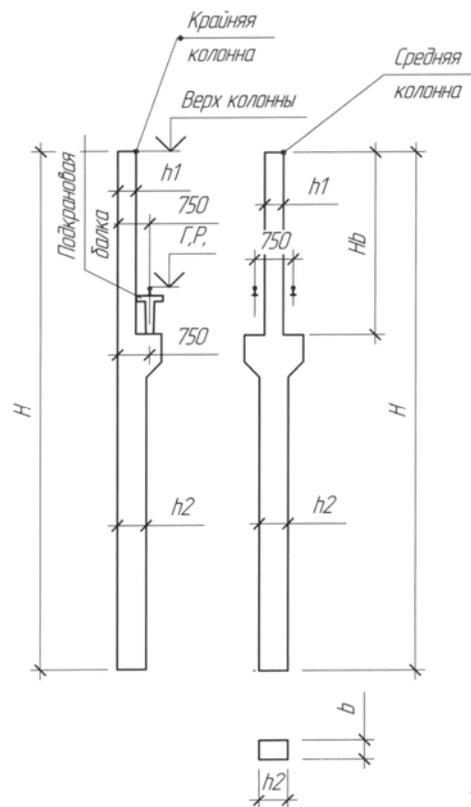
Конструкция колонн прямоугольного сечения для зданий с мостовыми кранами
